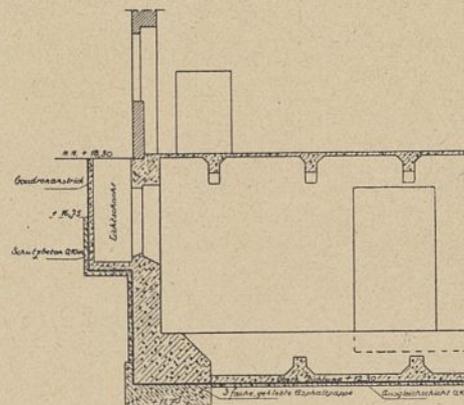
Dichtung der Kellersohle und Wände gegen Grundwasser. M. 1:50.
